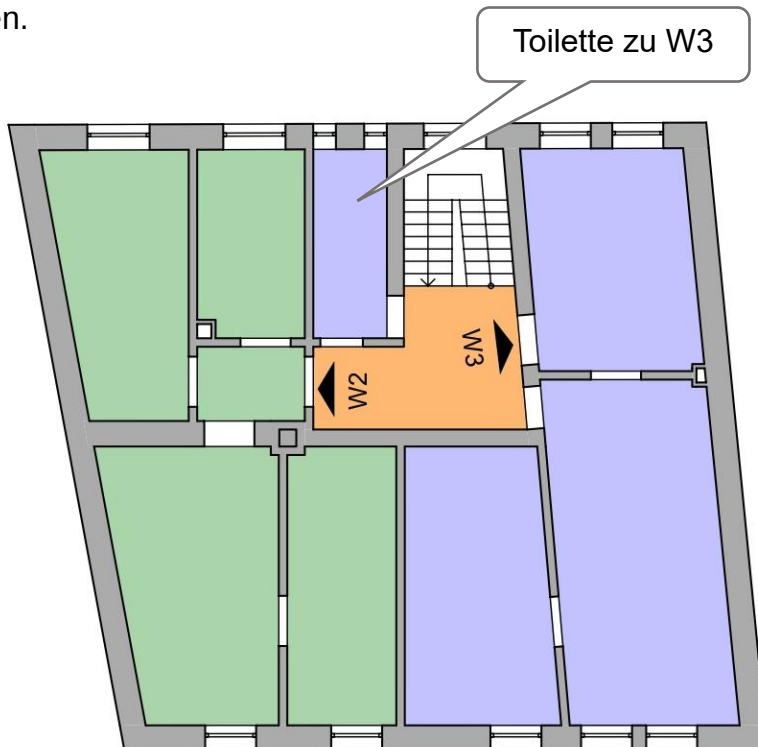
Grundrissdarstellung 2. Obergeschoss
